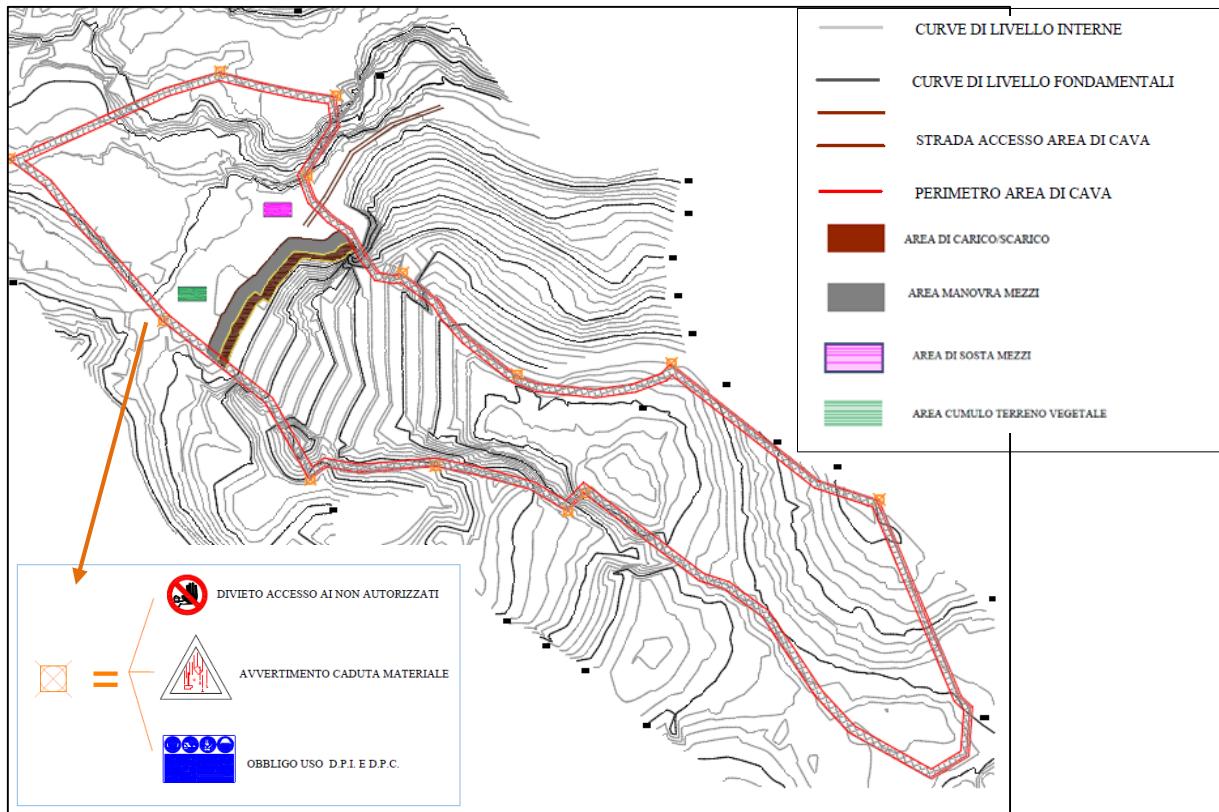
STRALCIO CANTIERIZZAZIONE 1° STADIO DI COLTIVAZIONE
